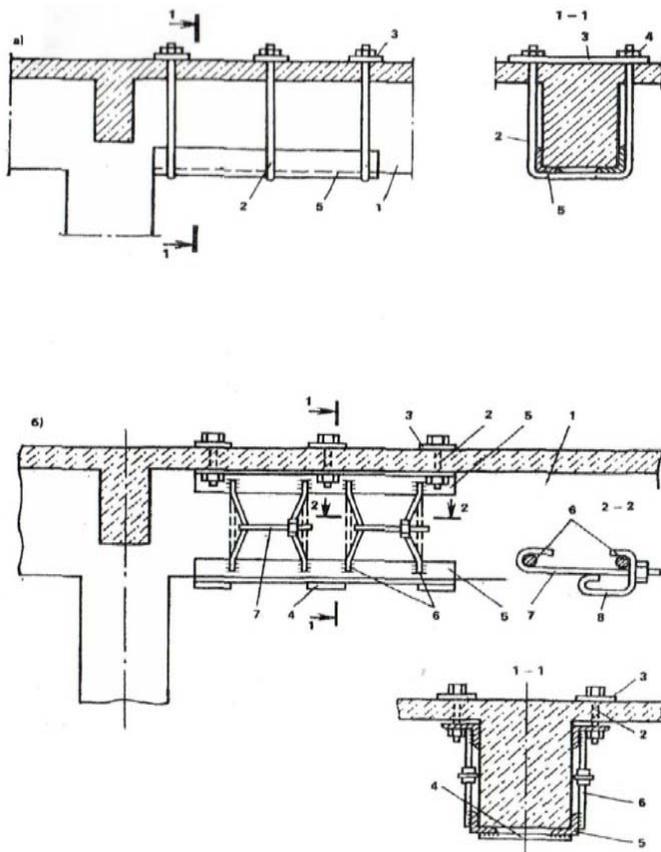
Варианты усиление балок на восприятие поперечных сил:
